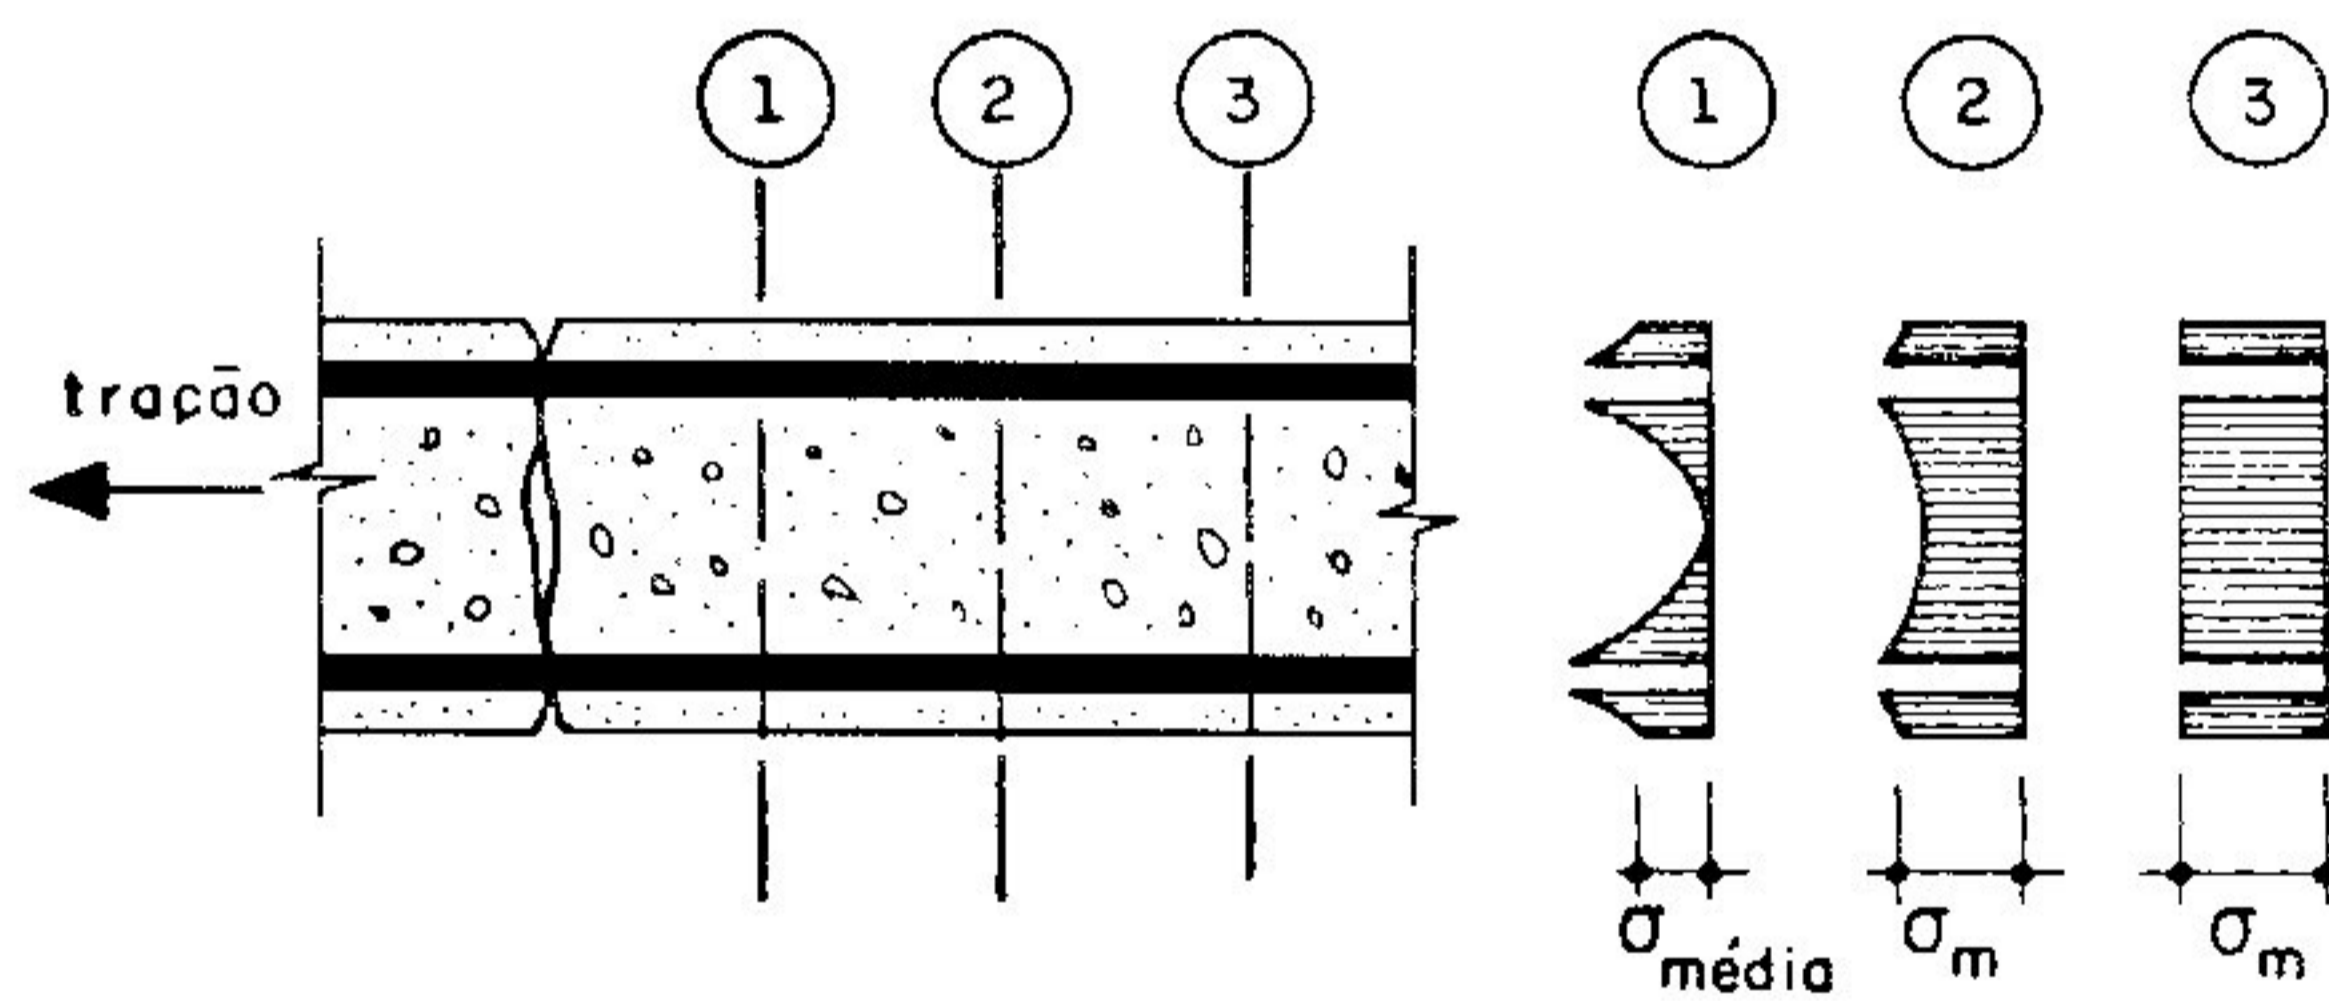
Distribuição de tensões no concreto fissurado. [Proença (1988)]
